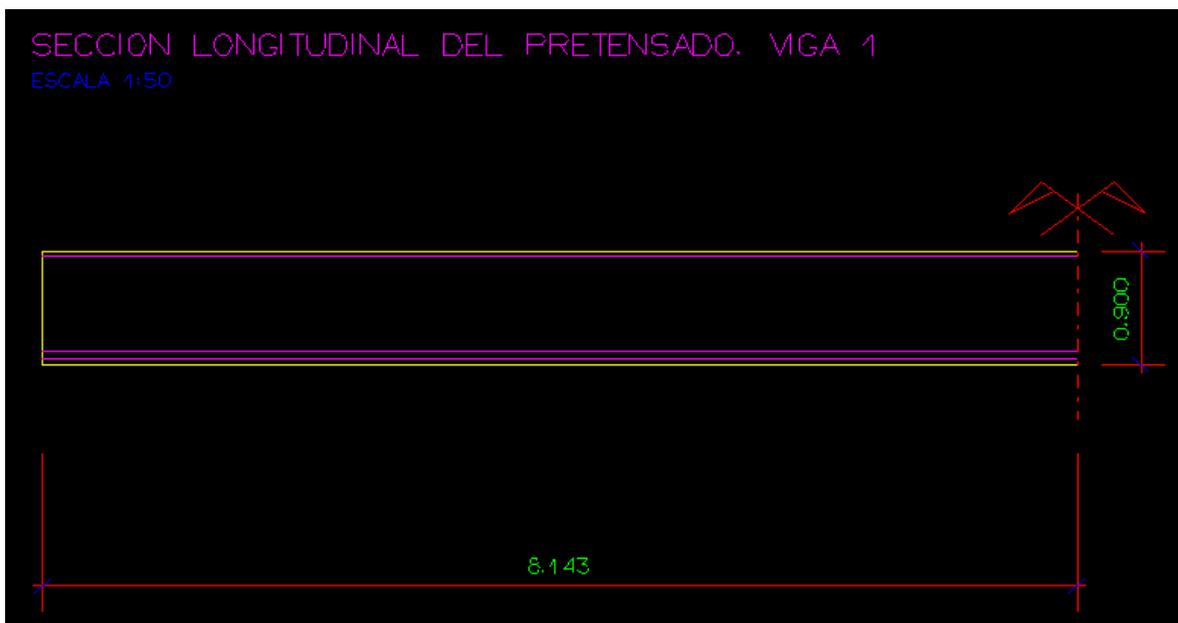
Figura *Sección longitudinal pretesado
